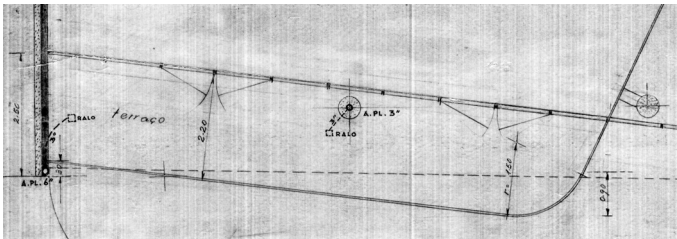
Ampliação do detalhe do pilar com tubulação de águas pluviais embutida
